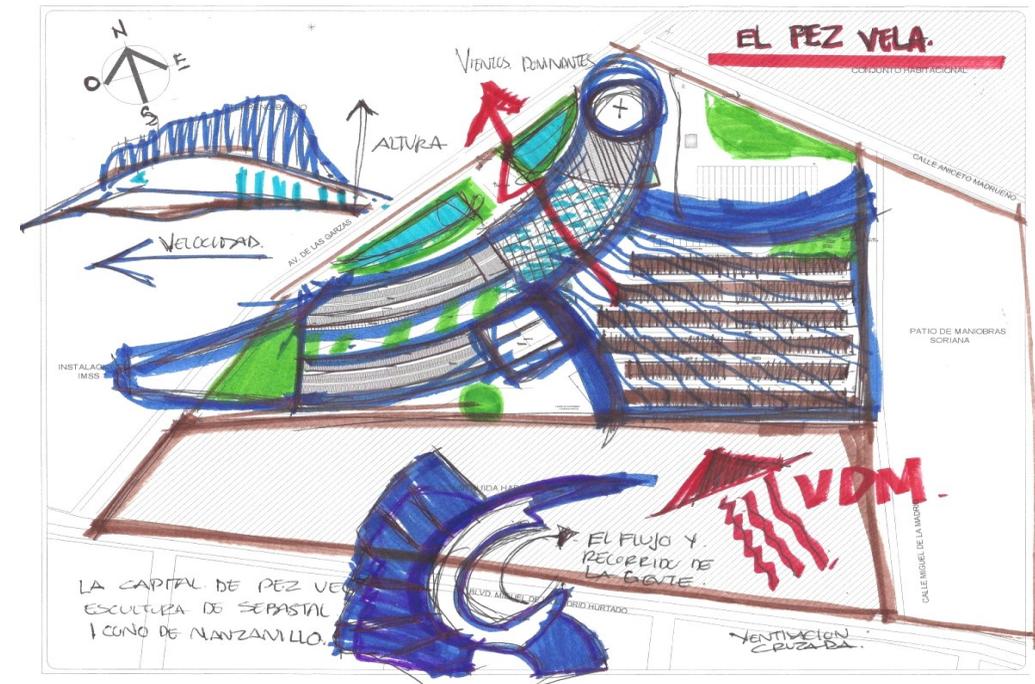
imagen conceptual, basada en la anatomía del pez vela. Fuente: croquis elaborado por JOGA
